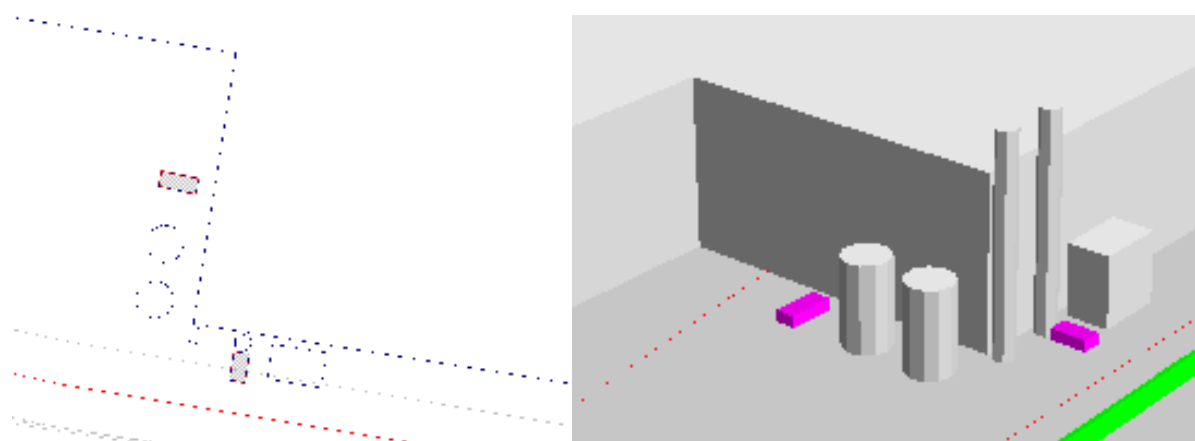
Stralcio planimetrico e visione 3D con l'individuazione posizione sistemi di abbattimento (stato di modifica)
